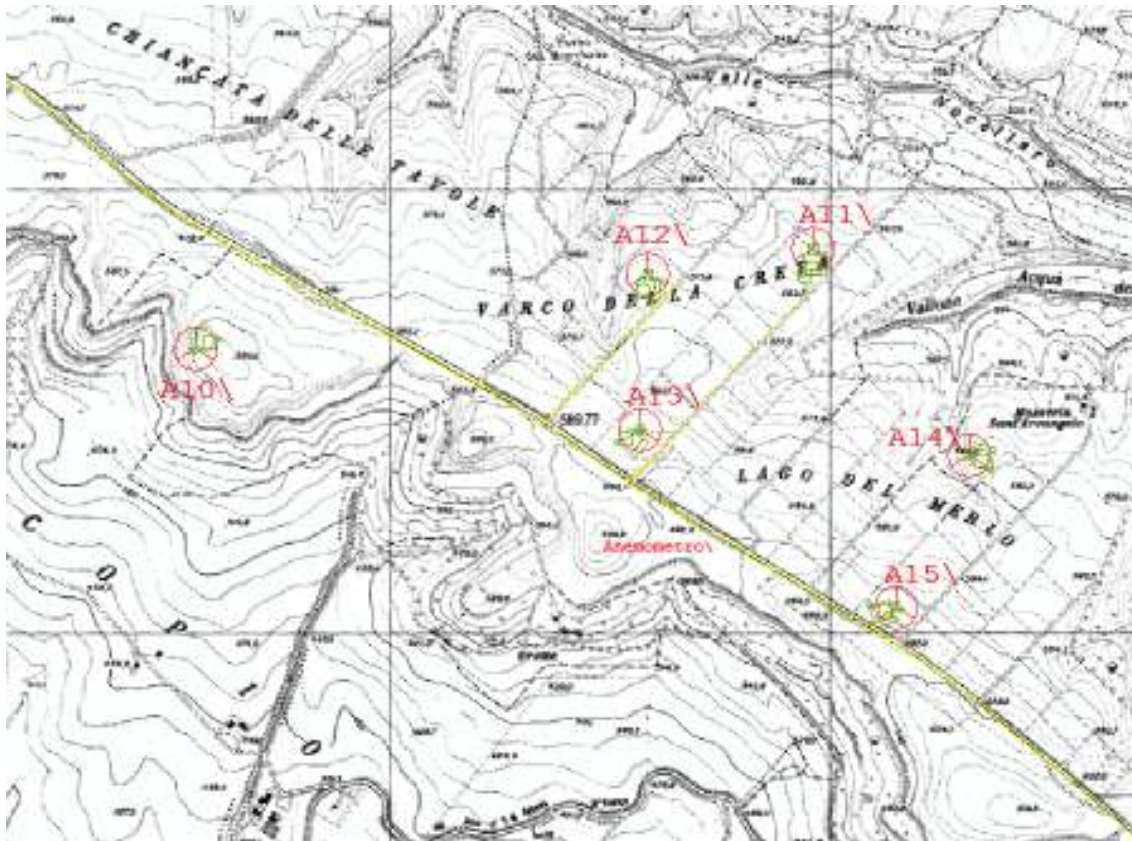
Particolare di Strade e Piazzole interessate dalla costruzione del parco su CTR.
